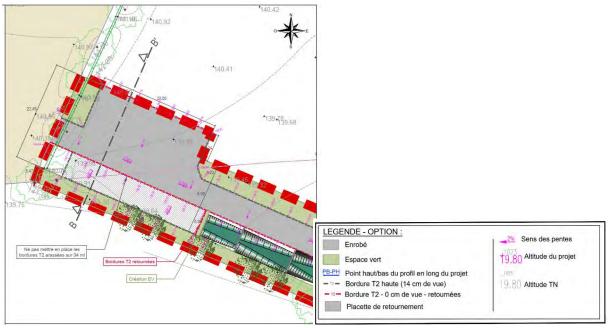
Plan de travaux- Voie Sud - Option- Placette de retournement (Source : URBAe, 5 juin 2024)
